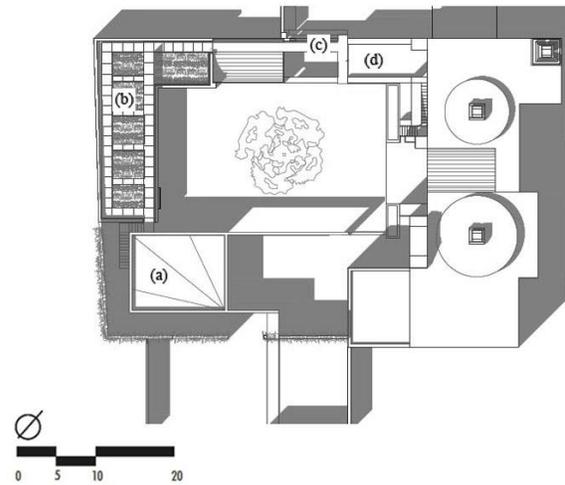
Planta Arquitectónica Nivel de Patio.
